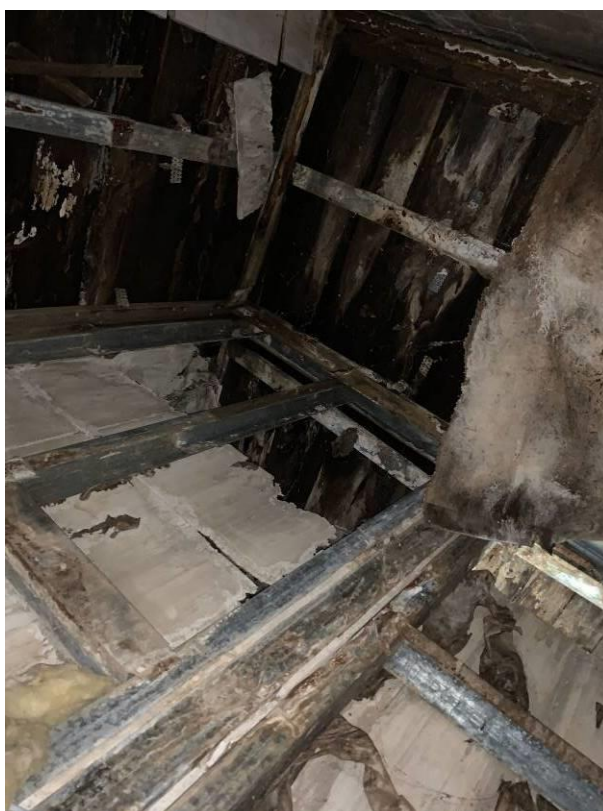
Перекрытие санузла в осях 4-7/И-К над 1-м этажом
